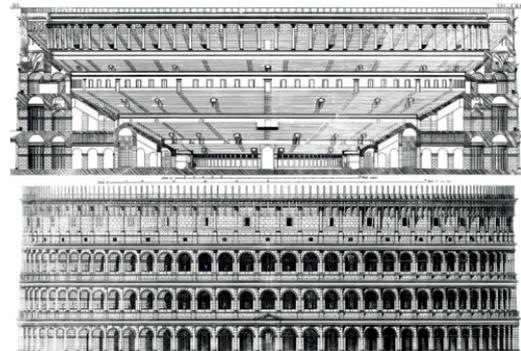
Anfiteatro Flavio, sezione e prospetto ↑
